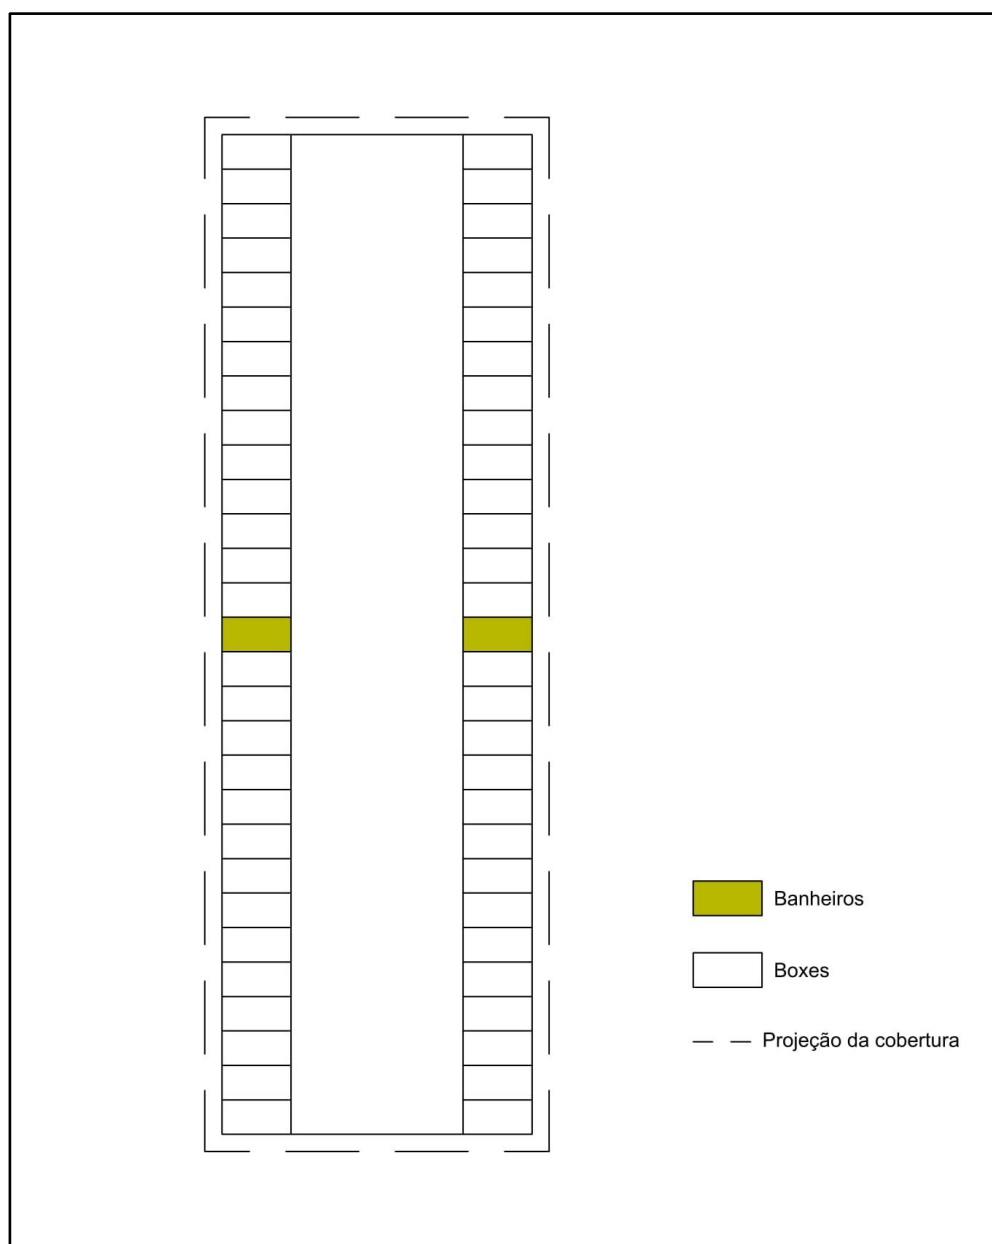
Planta do primeiro pavimento dos pavilhões de comércio atacadista (Escala 1:1.000)
